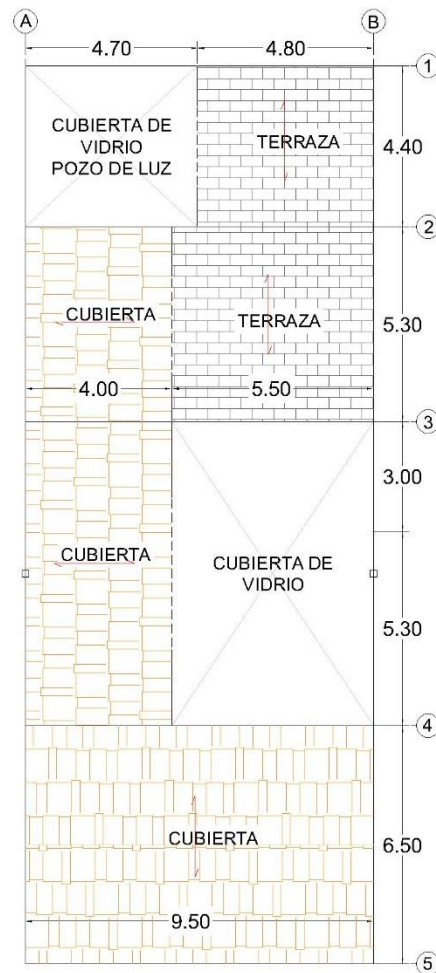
Distribución del sistema de cubierta y orientación de las viguetas
